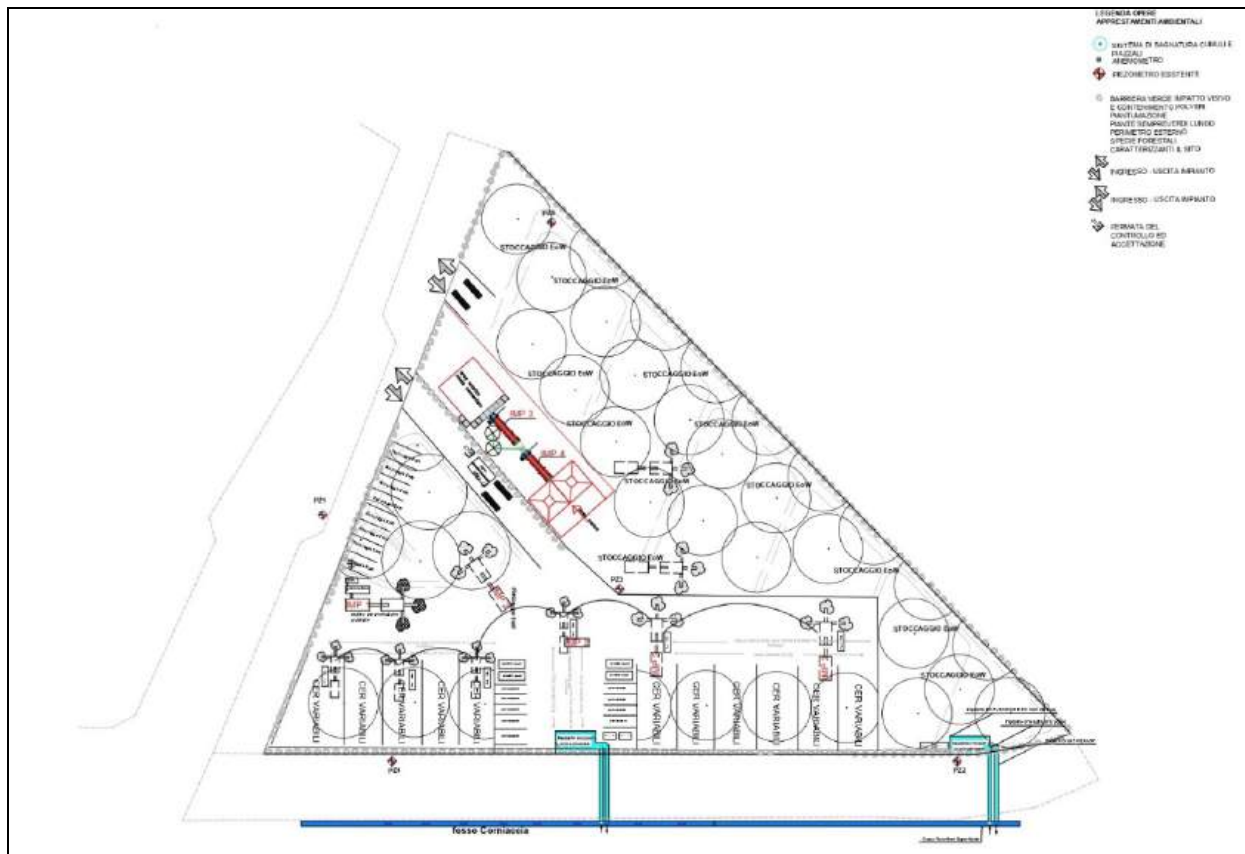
Planimetria dell'impianto con esatta ubicazione dei piezometri.
